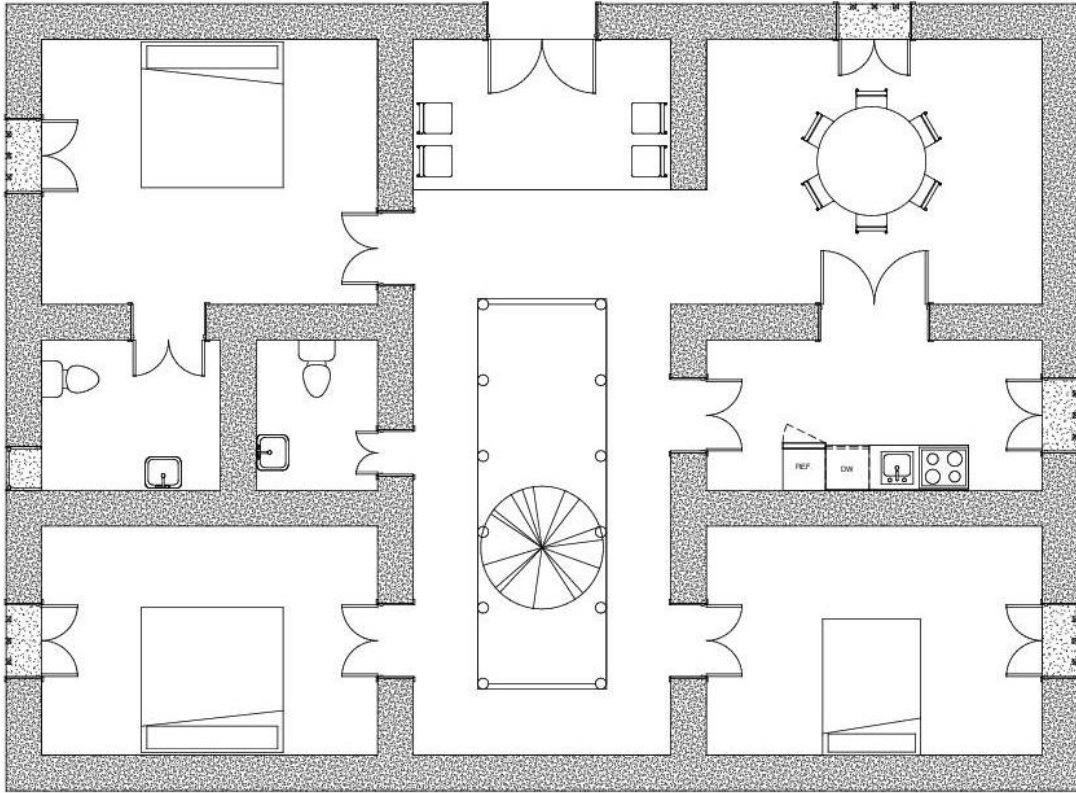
Planta arquitectónica del Modelo 2 - Santander. Fuente: Elaboración propia.
